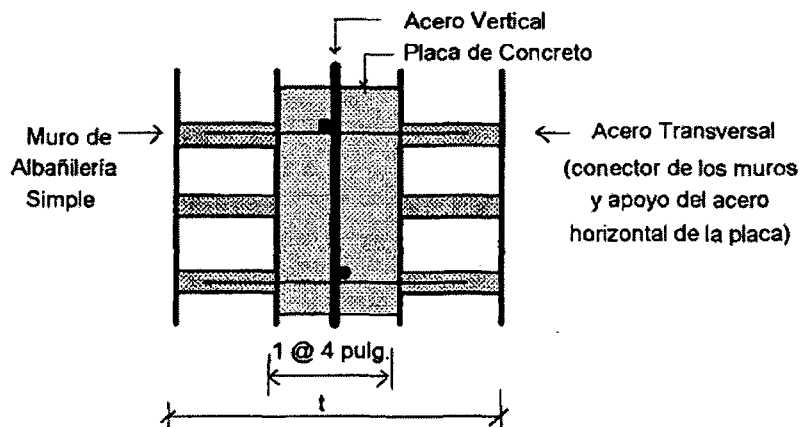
Sección transversal Muro Laminar o Sandwich (San Bartolomé, A. 1994)
